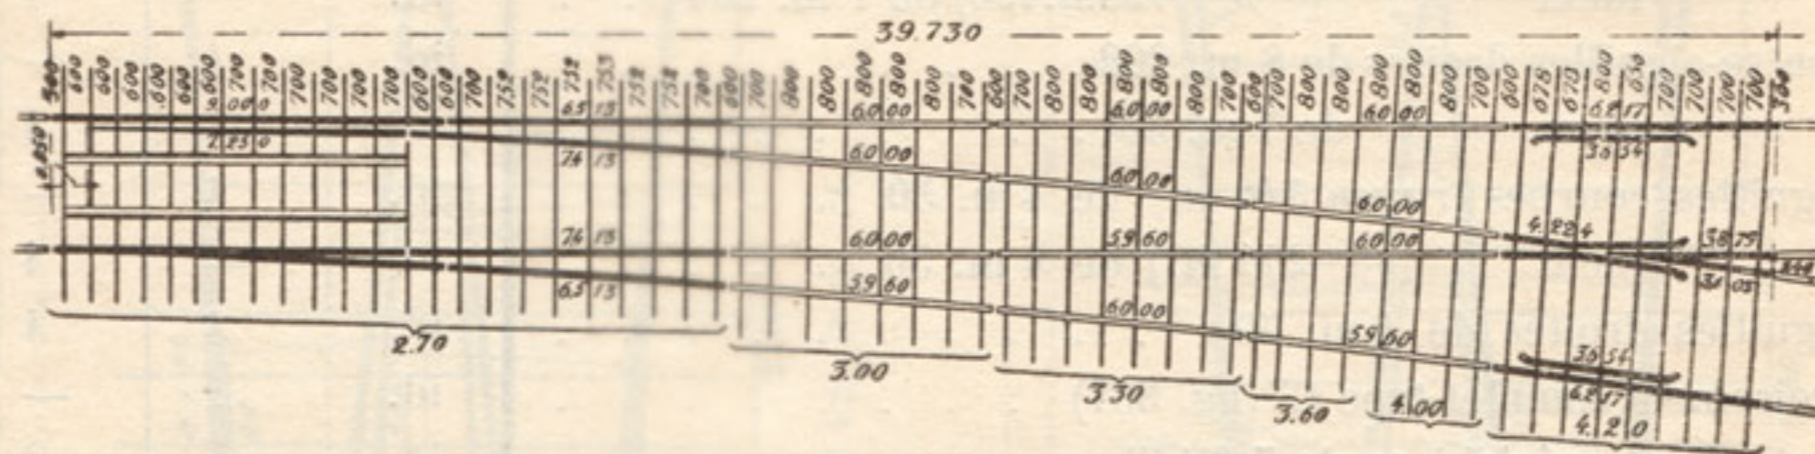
Raccordement de l'aiguillage S et du croisement C¹ en rails de 52 kg. par m. ct.
